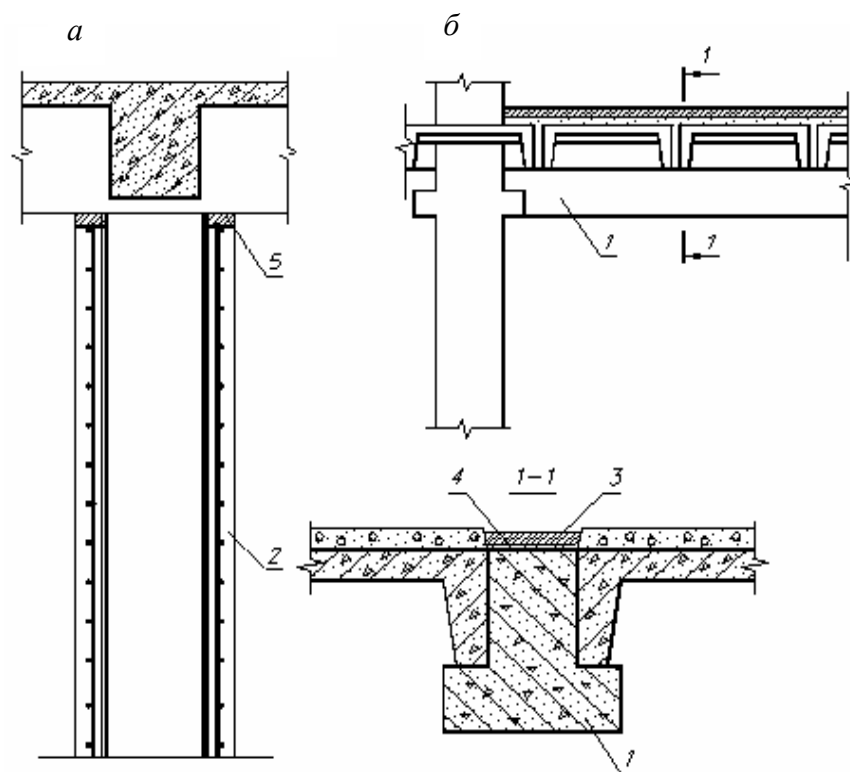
Усиление сжатой зоны конструкции приклеиванием: *а* – сборных железобетонных элементов; *б* – дополнительной листовой арматуры; 1 – усиливаемая конструкция, 2 – сборный железобетонный элемент с продольной рабочей арматурой, 3 – листовая арматура, 4 – полимерраствор, 5 – монолитный бетон зачеканки
